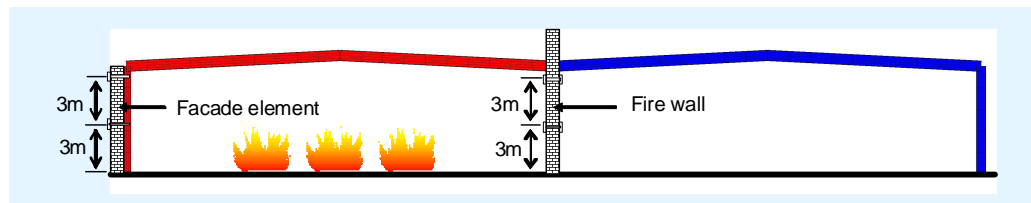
Diseño de detalle para elementos de fachada y muros cortafuegos
